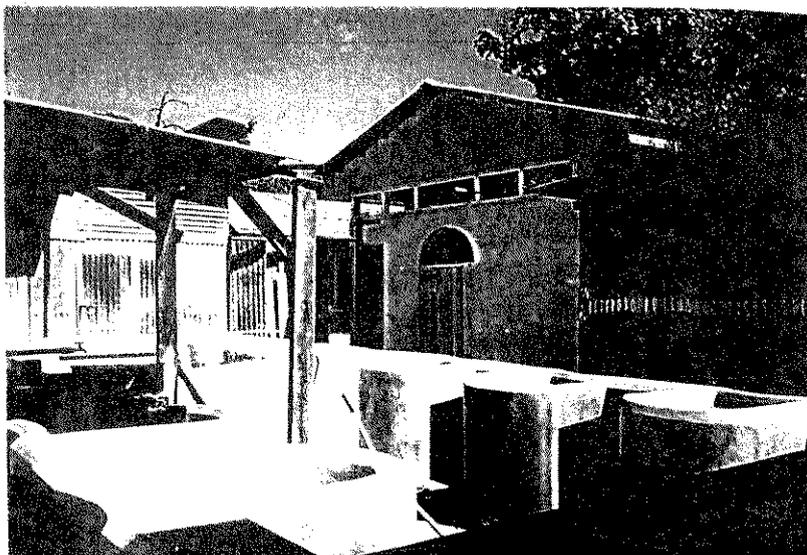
Detalle de pila ubicada al surponiente del edificio, estado actual ya en desuso.
